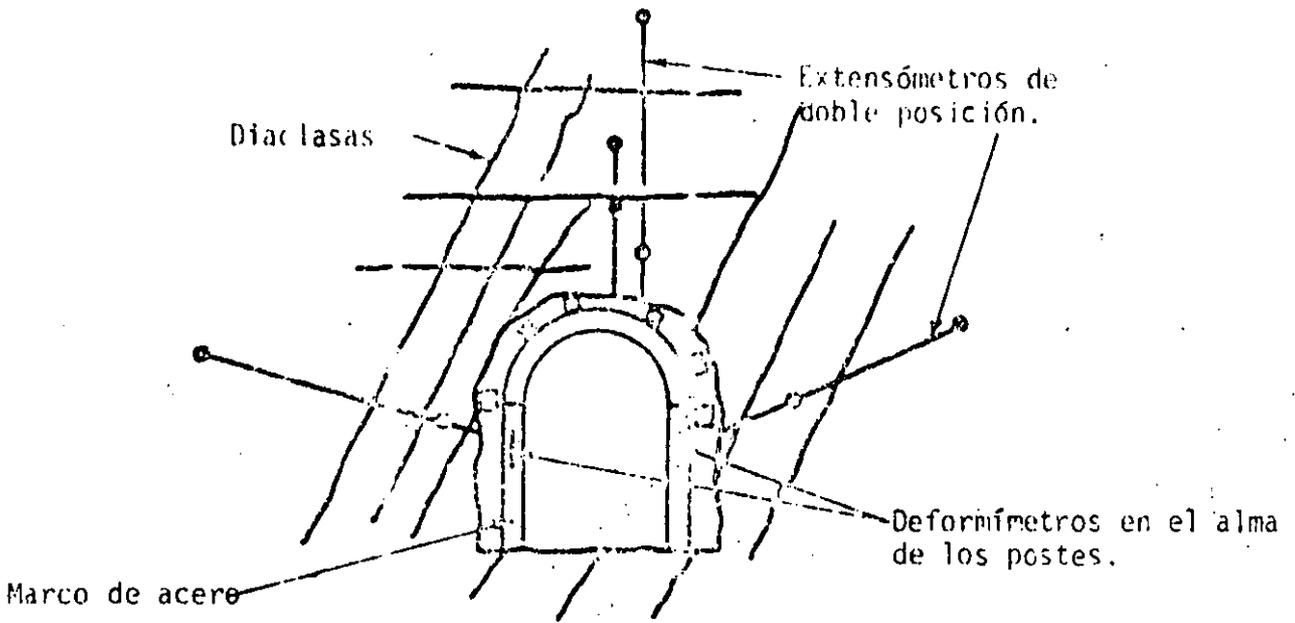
A. Instrumentación en un túnel profundo en roca con ademe de marcos metálicos.
